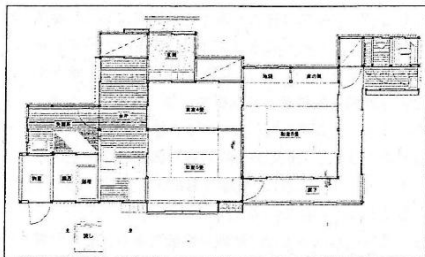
我孫子の母屋現状平面図 (山村映子作成)
